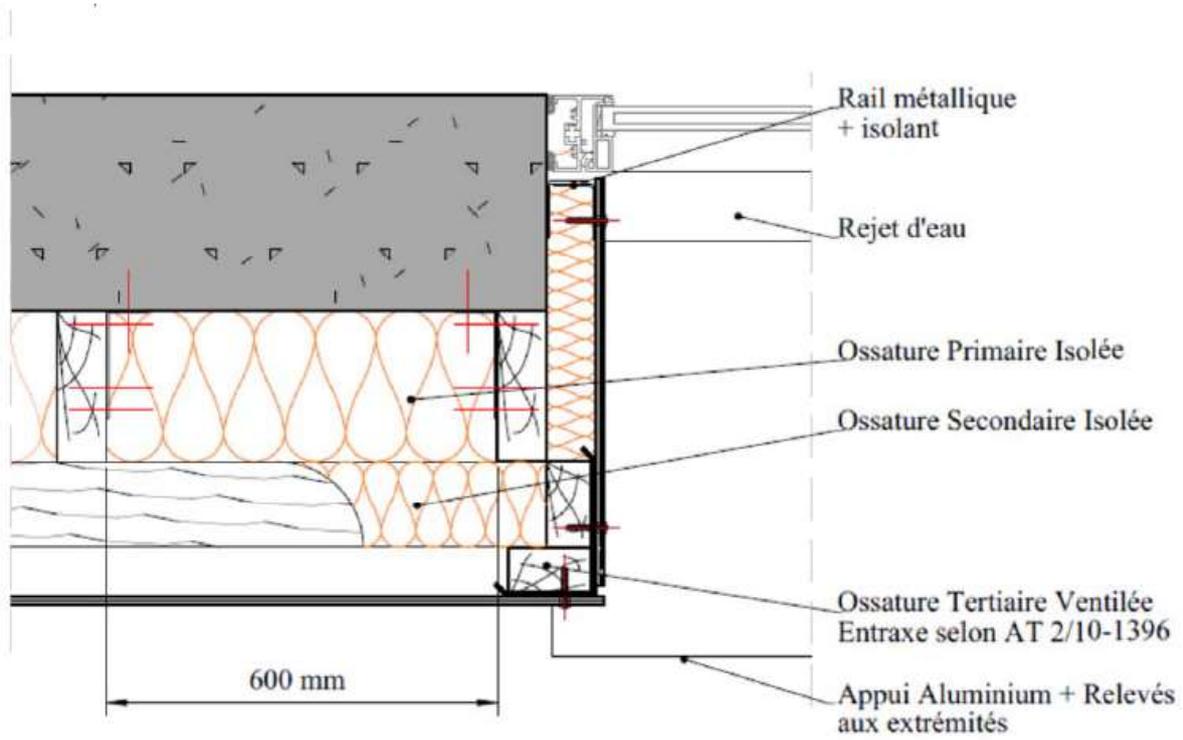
Traitement sur BA en multi réseau -Coupe sur tableau
